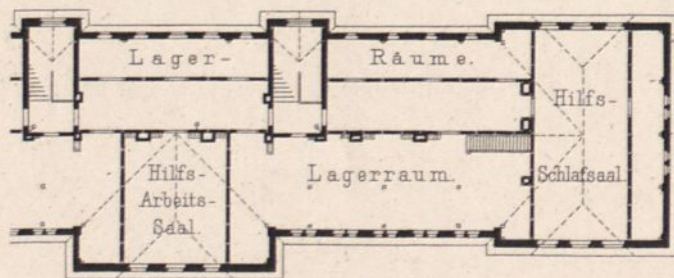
Krankenhaus A. Theil des Dachgeschosses.
